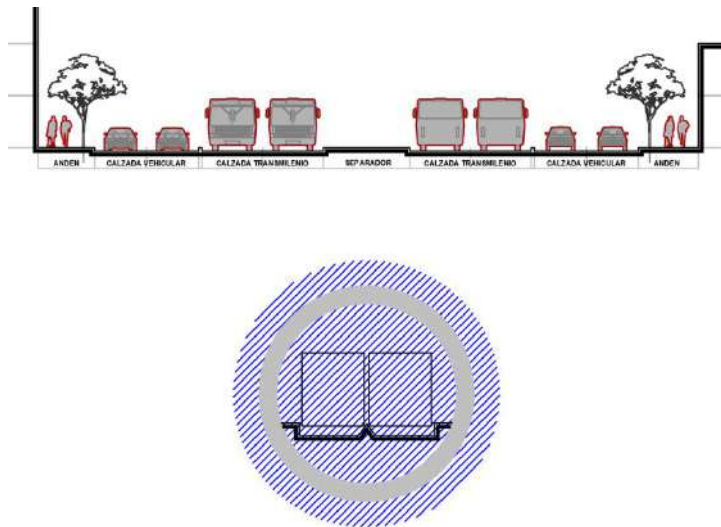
Afectación al tráfico sistema constructivo elevado
